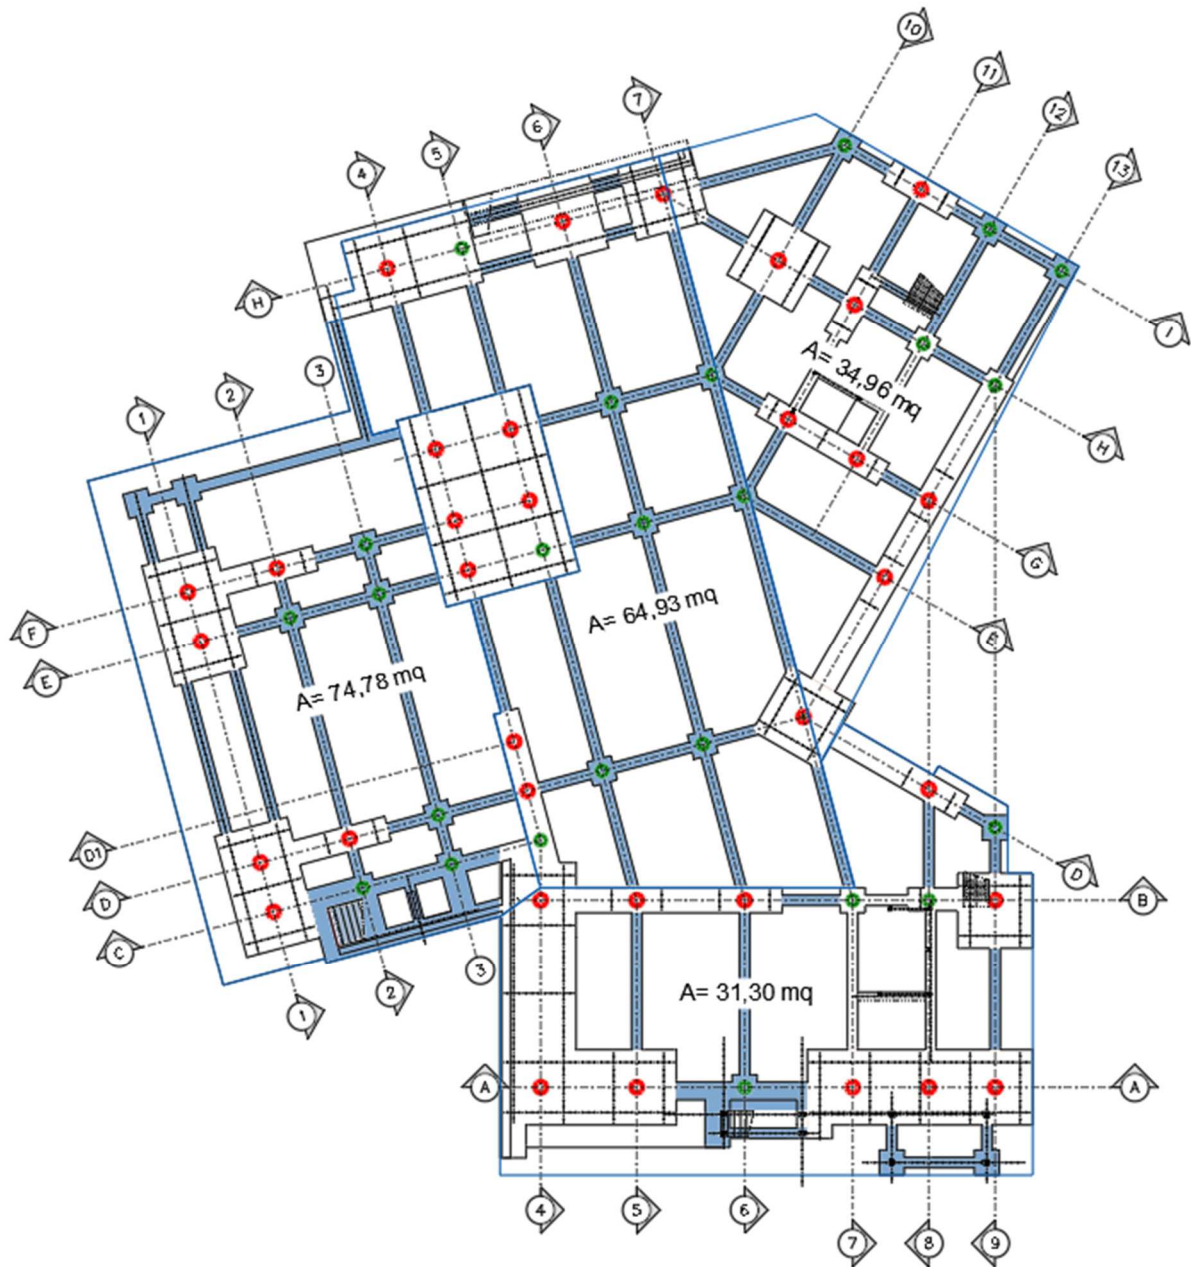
Piano fondazione: area cordoli e plinti con H=100 cm (campitura color azzurro)
